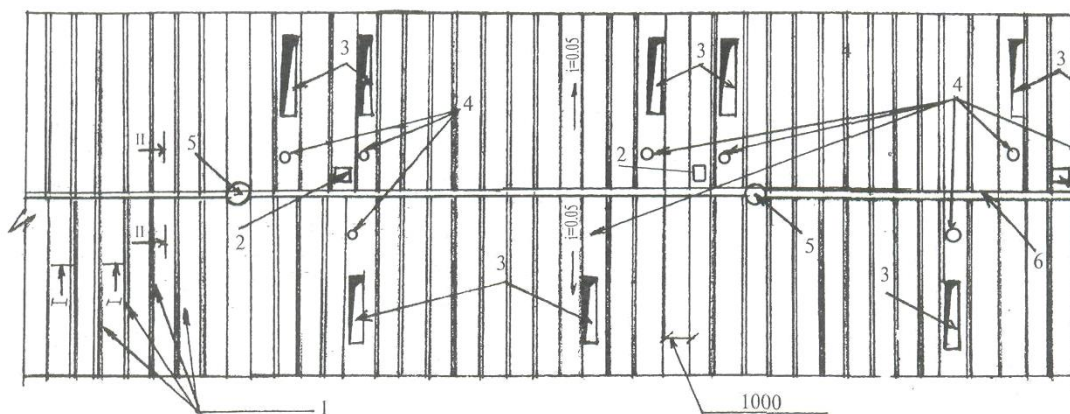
Устройство совмещенной вентилируемой крыши:
